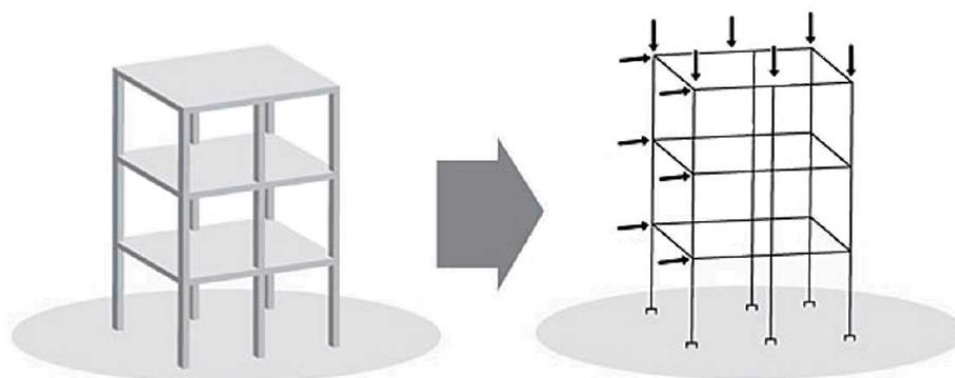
Pórtico espacial. (Fonte: Kimura; 2018)
